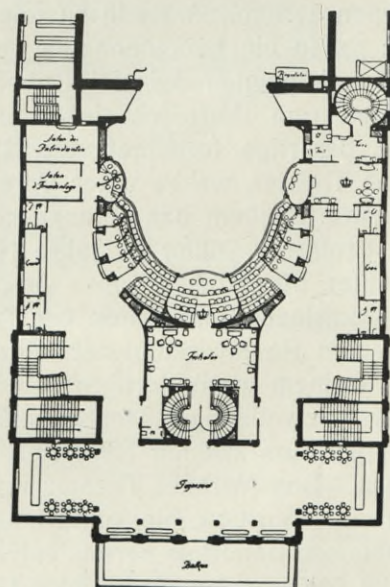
Hoftheater zu Weimar. Grundriß des Zuschauerhauses in Höhe des I. Rang.
